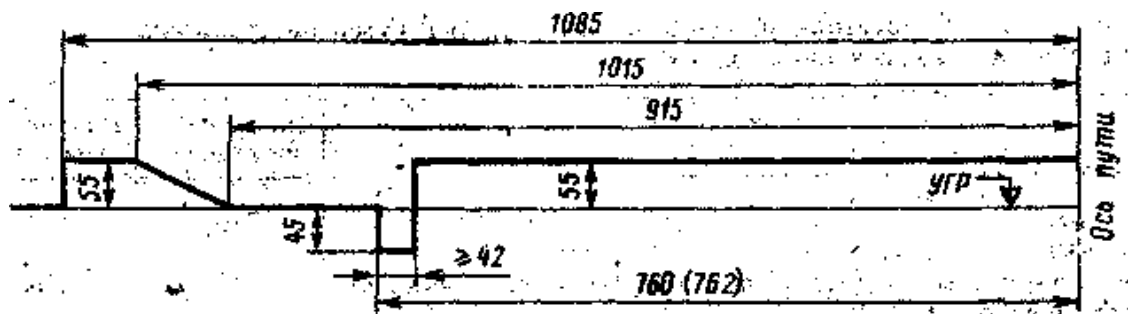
Нижнее очертание габарита С для двойных перекрестных стрелочных переводов. Оно устанавливает допускаемые нормы возвышения над уровнем головки рельса и удаления от оси пути частей тупых крестовин.
